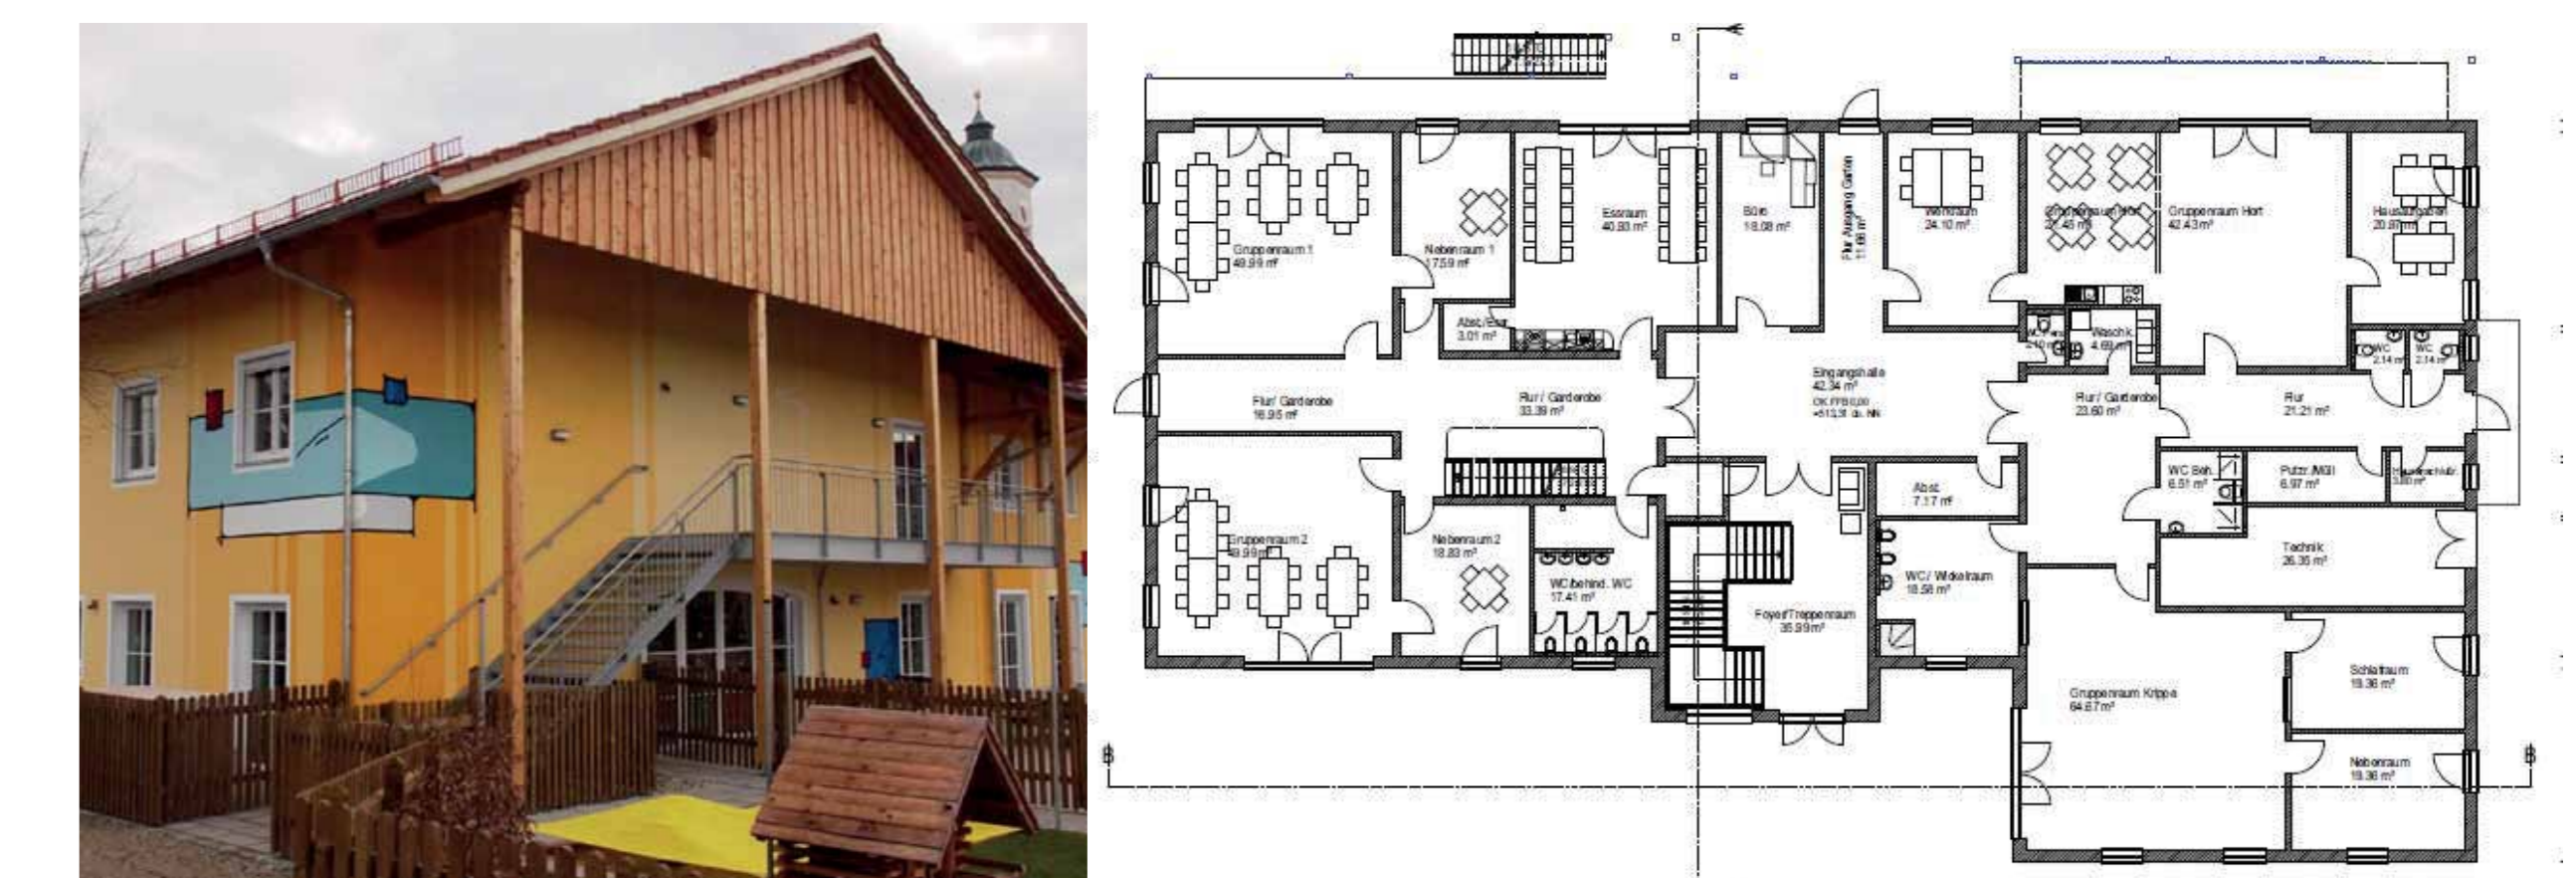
und 6: Außenansicht und Erdgeschoss-Grundriss des Kinderhauses „Schatzkiste“ in Albaching
